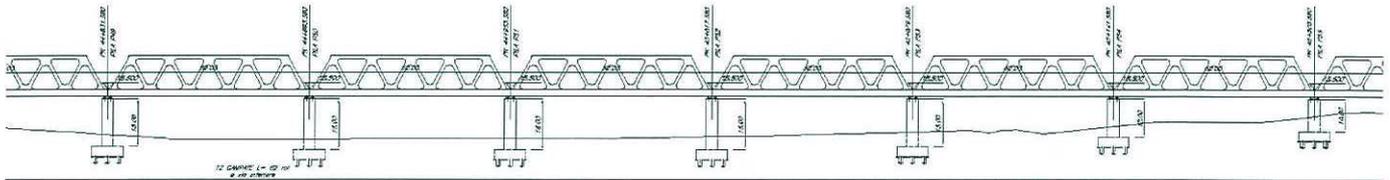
Prospetto viadotto su AV in corrispondenza dell'attraversamento dell'Isonzo.
